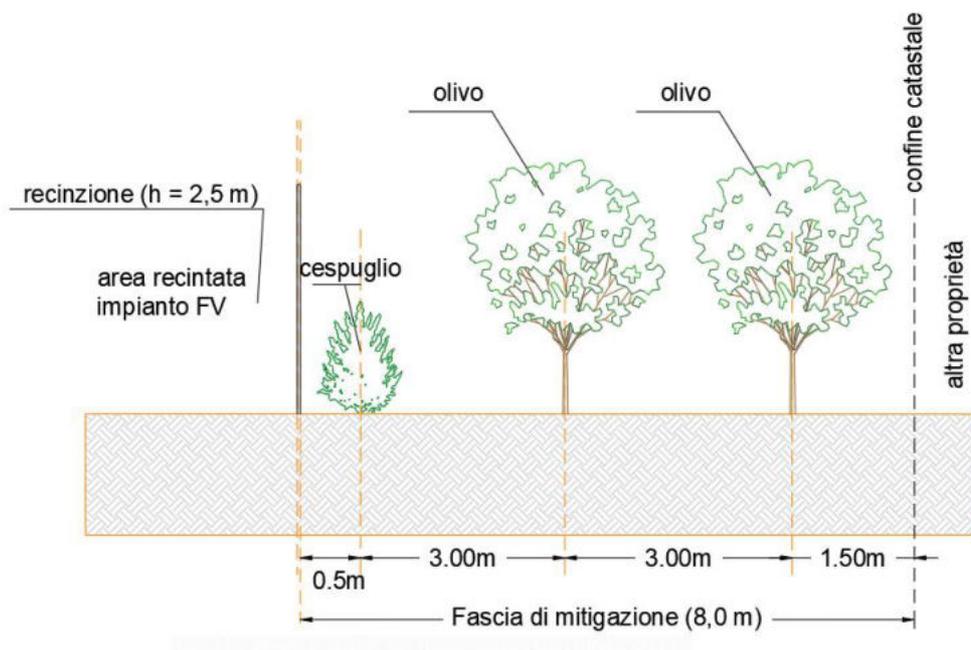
Stralcio di sezione dell'area perimetrale dell'impianto.
